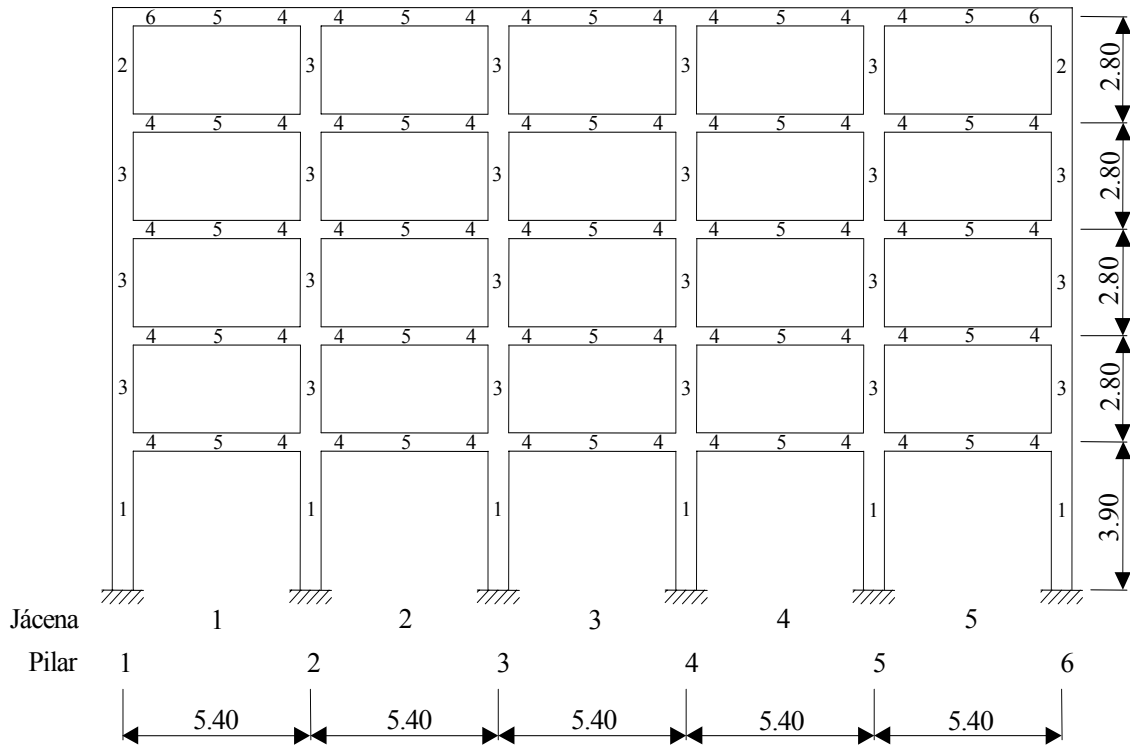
Pórtico de hormigón armado analizado en el ejemplo
